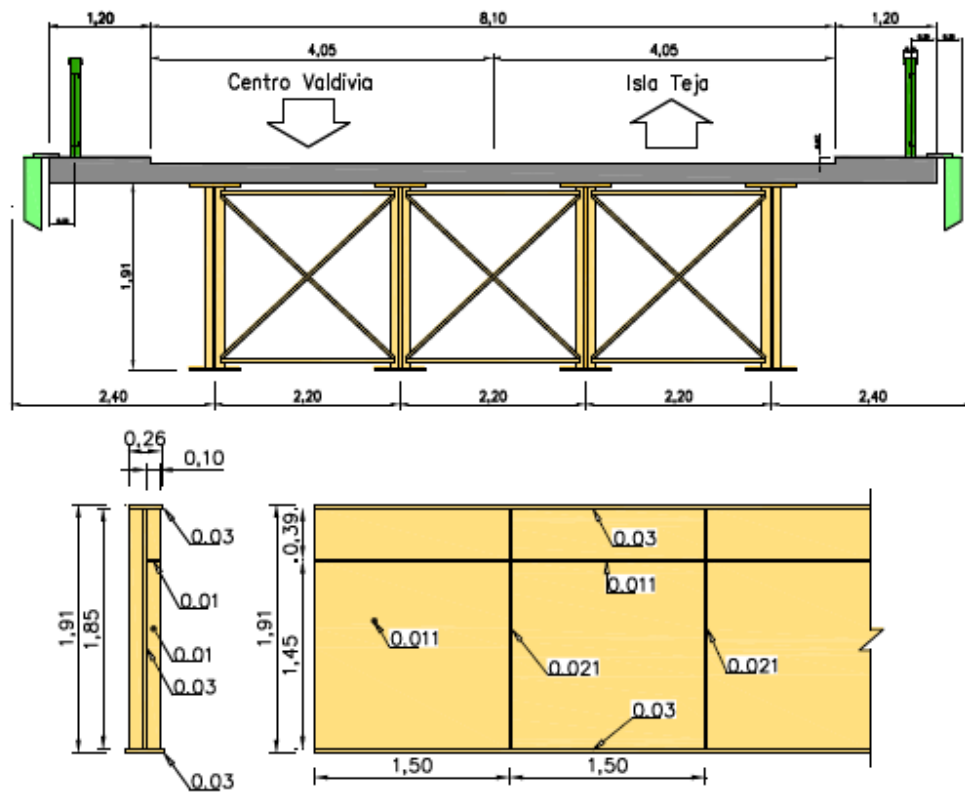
Sección transversal del tablero mixto y detalle de la viga metálica.
